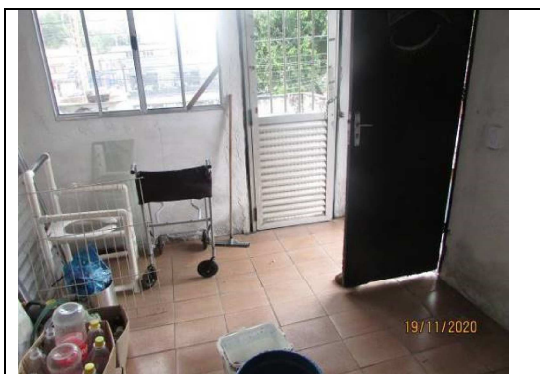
Vista da entrada do wc da lanchonete.
